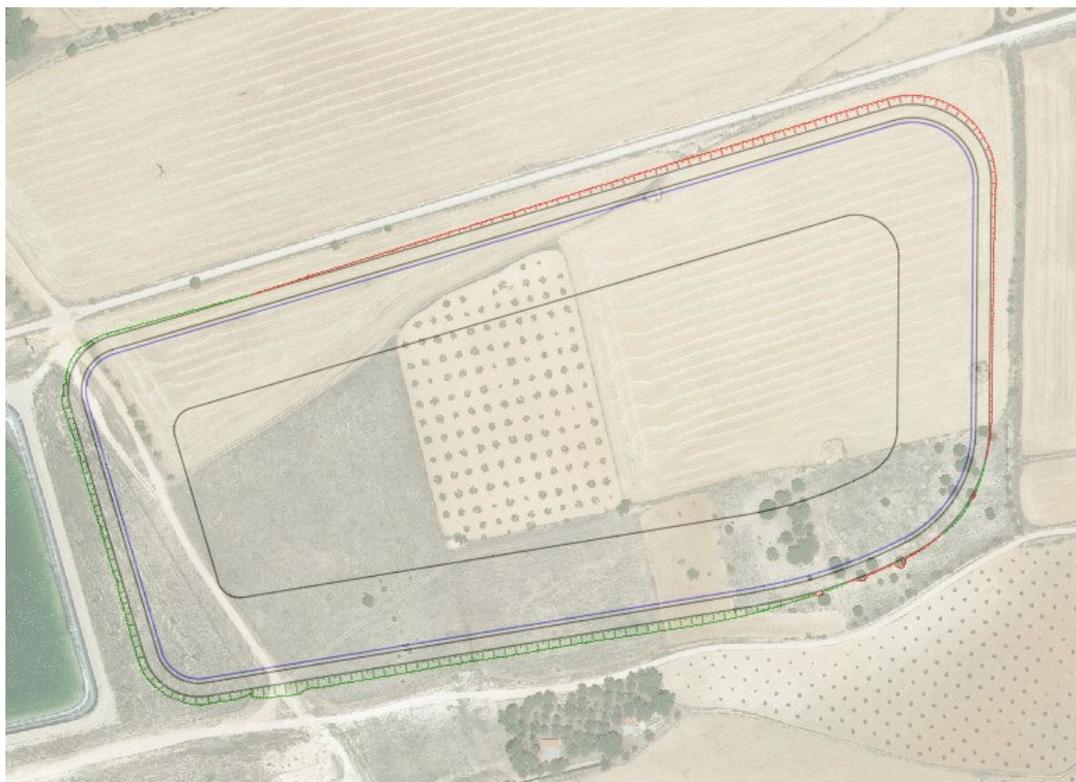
Vista en planta de la balsa de la alternativa 2. Fuente: Elaboración propia a partir de PNOA © cedido por IGN.
